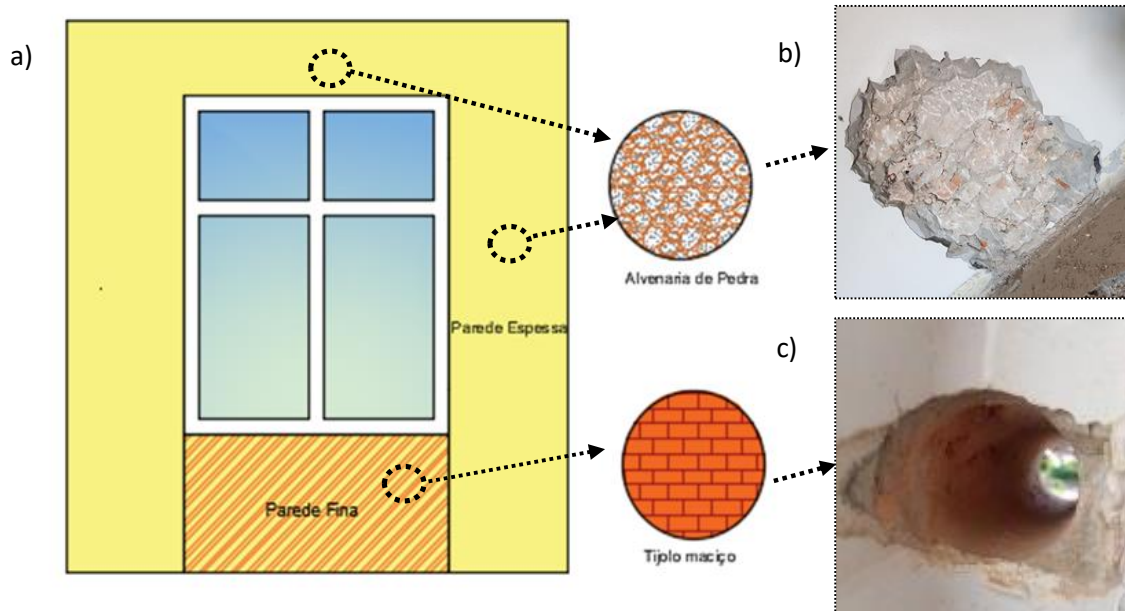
a) Apresentação esquemática da fachada dos gabinetes; b) Pormenor da parede espessa; c) Furo transversal na parede fina.
